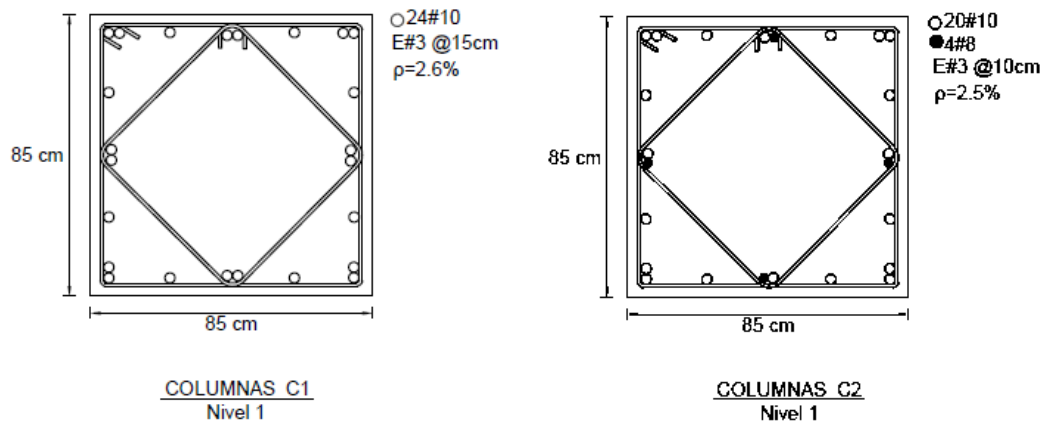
Armado de vigas y columnas diseñadas con las NTCC-04 para el edificio de 4 niveles con un sistema estructural a base de marcos dúctiles y muros diafragma
